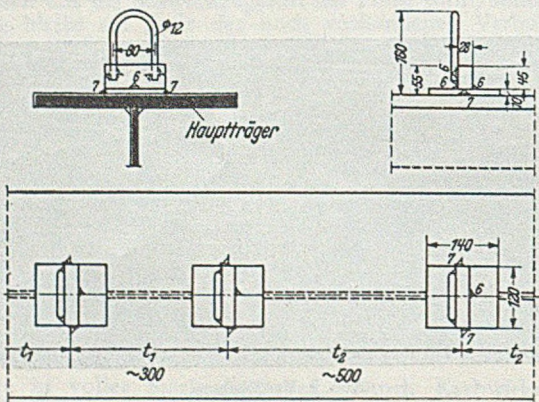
Dübelausbildung Euskirchen, AB-Brücke Birlinghoven-Dambroich und AB-Brücke Kölner Straße.
